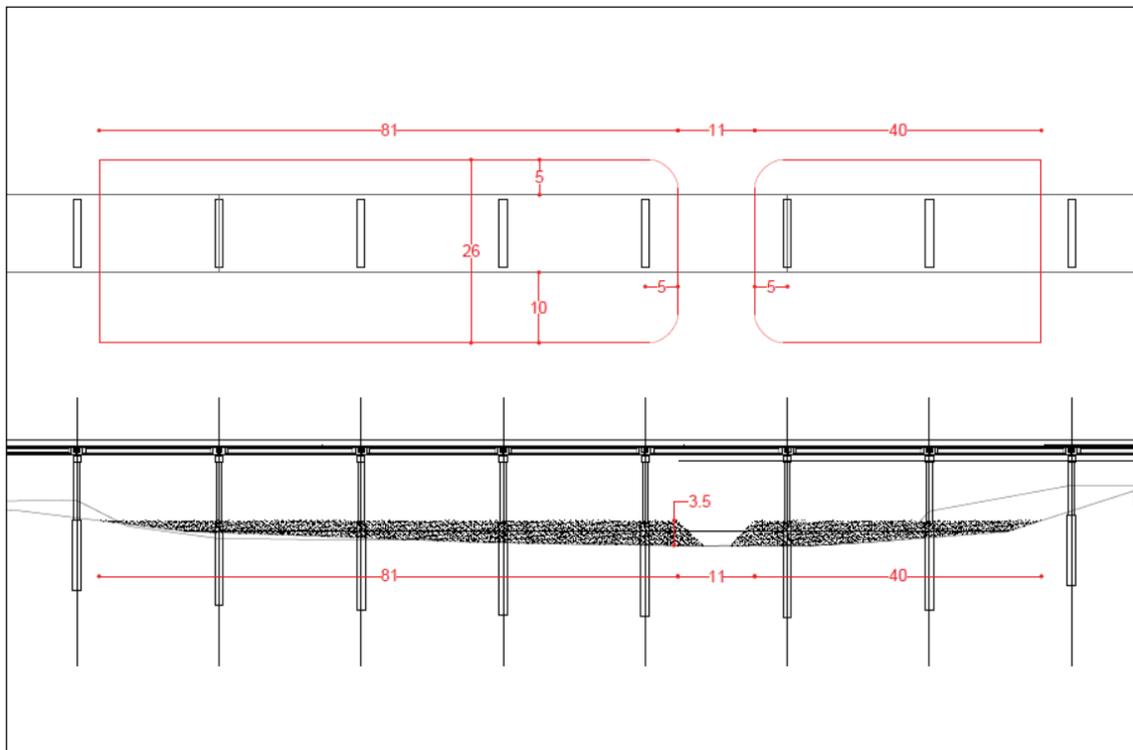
Esquema de ataguías a construir para la ejecución de las obras del puente.
